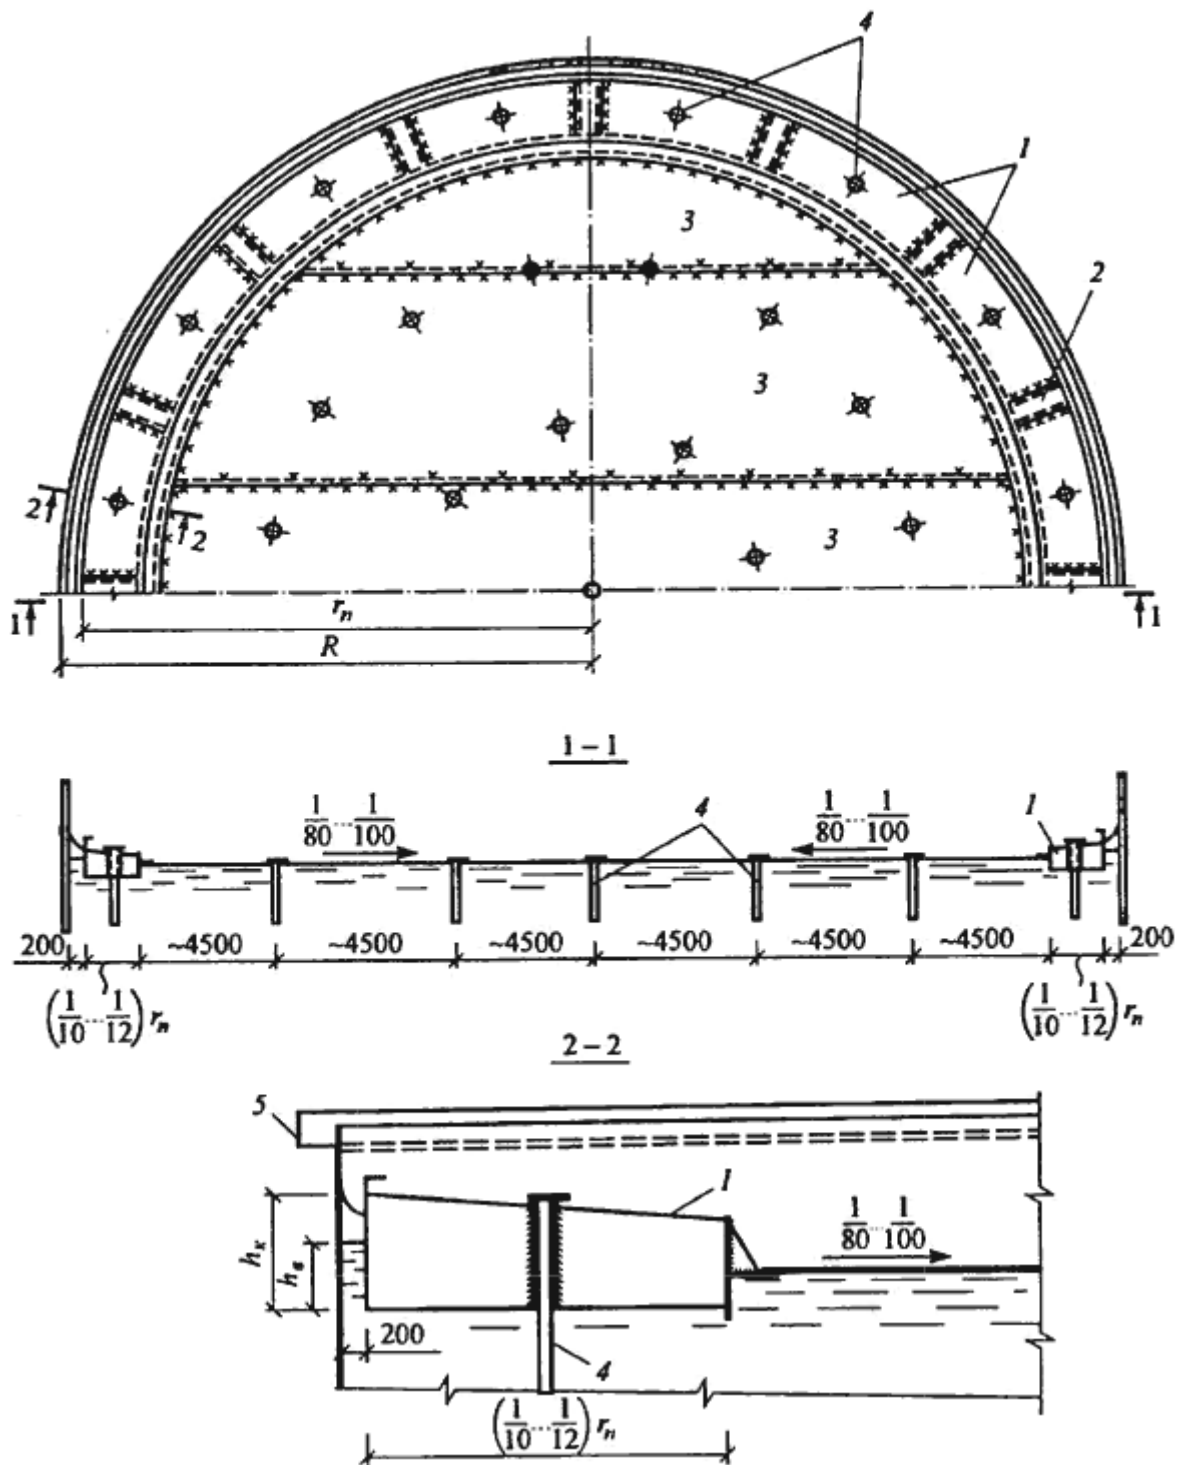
Схема однослойной гибкой плавающей крыши: 1-кольцевые короба; 2- монтажные соединения коробов; 3-мембрана; 4 - трубчатые стойки; 5 - кольцевой балкон
